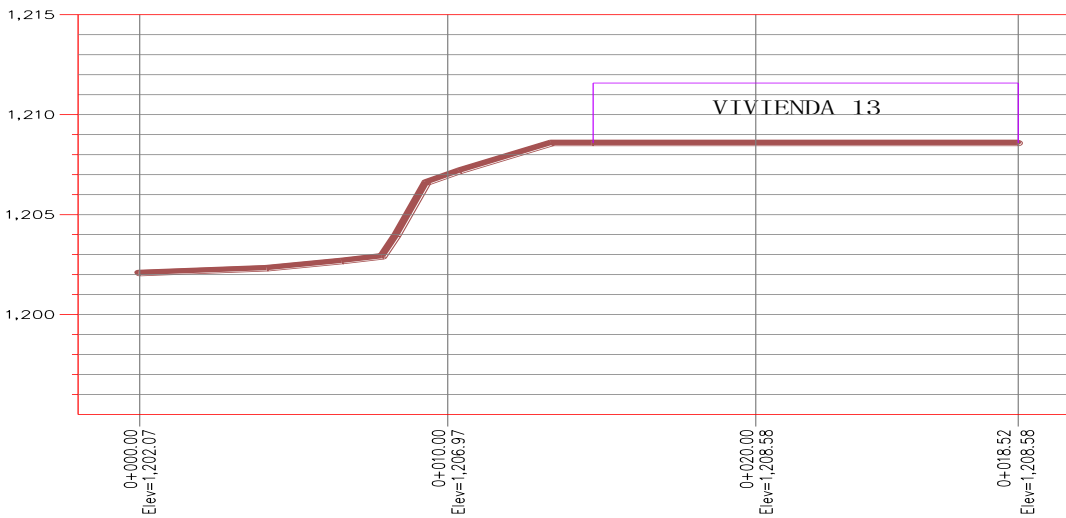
Perfil 5, talud #3 del sector de ladera estudiado.
